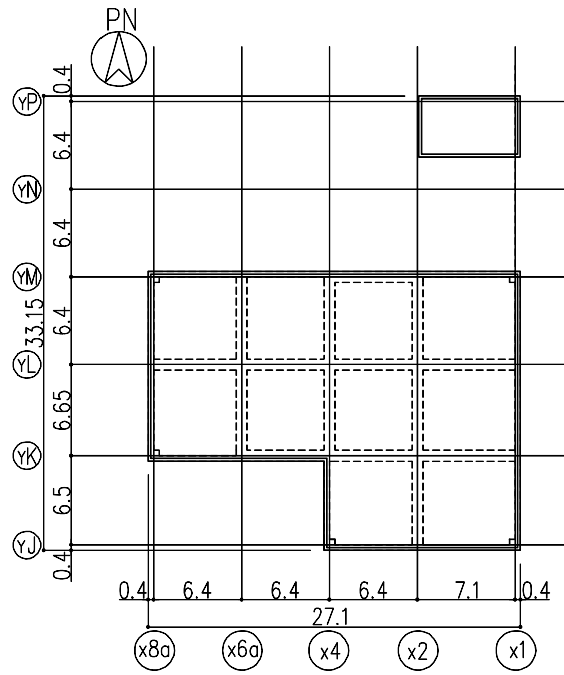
屋上階平面図 (G. L. +15.4) (单位: m)
